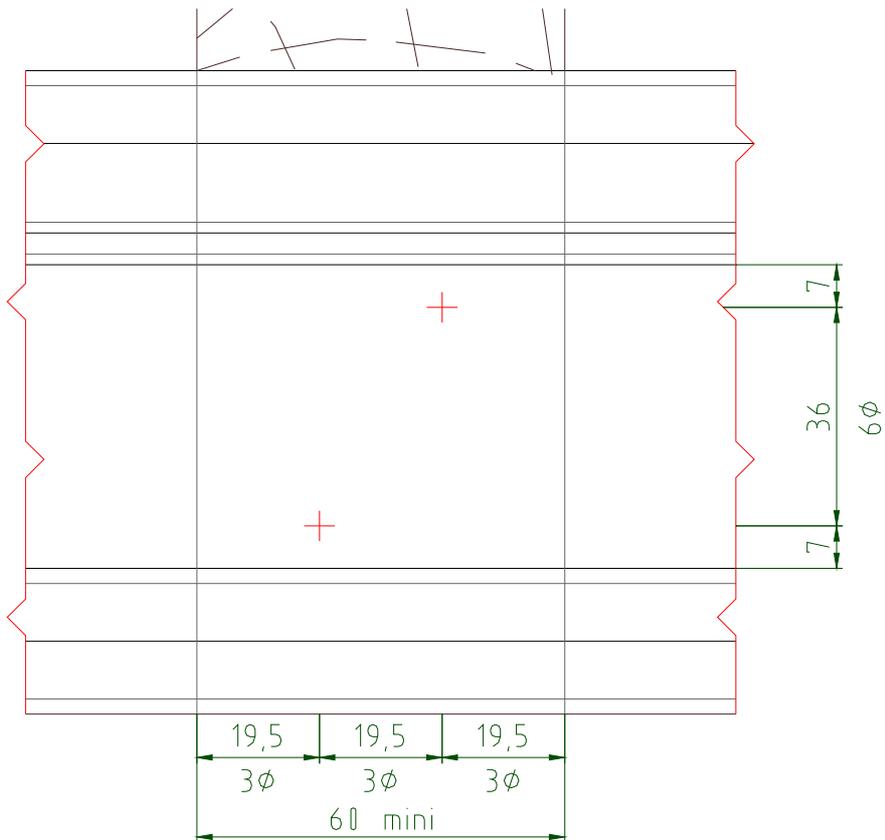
is – Détail avec 2 fixations en quinconce du rail horizontal sur ossature bois
